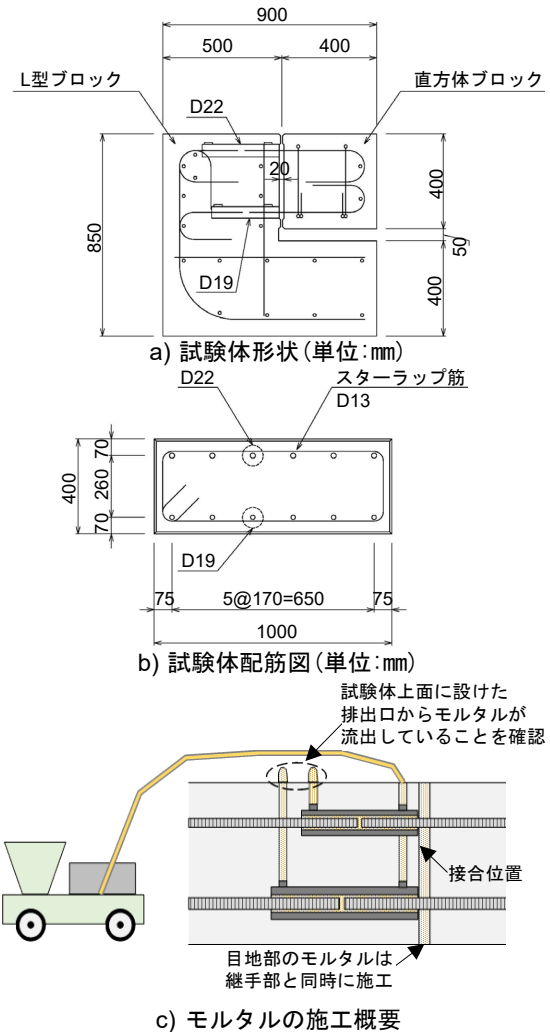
試験体の形状、試験体配筋図およびモルタルの施工概要
